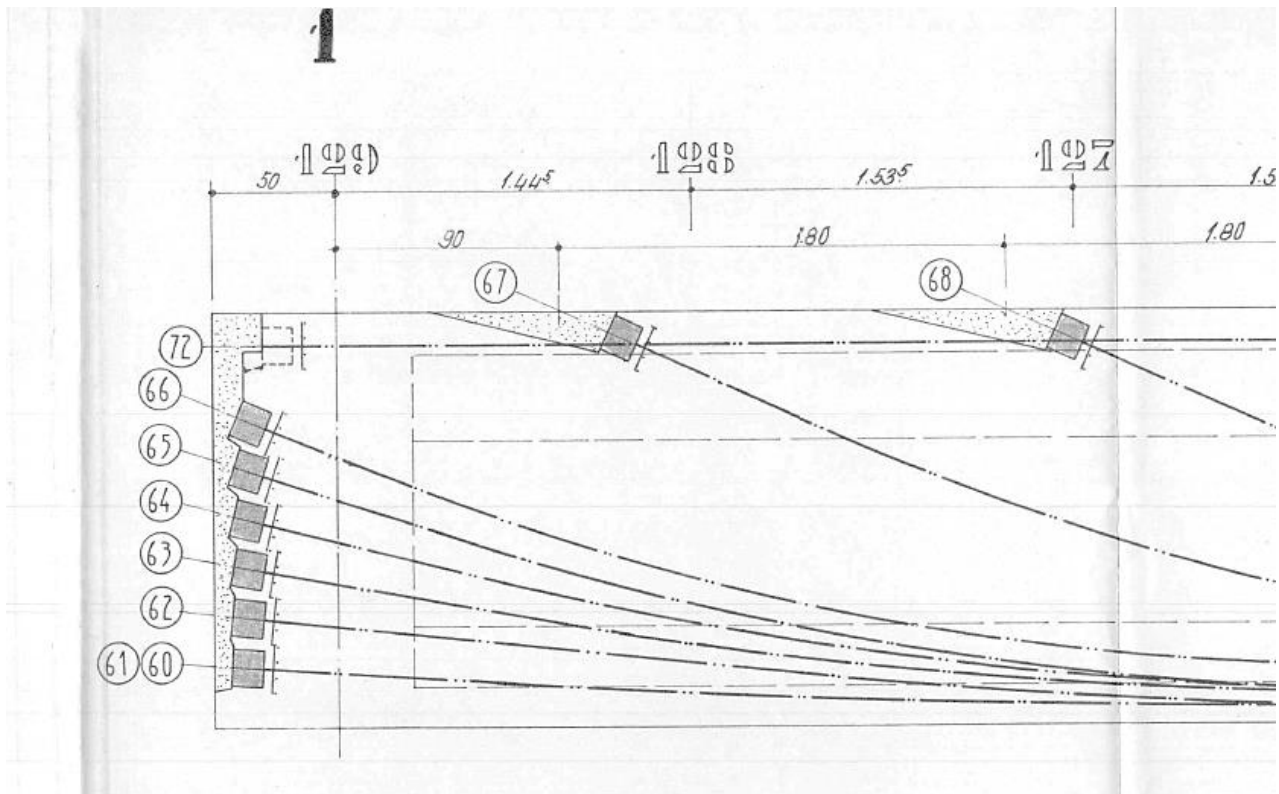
Extrait de plan de câblage – Elévation côté tablier
